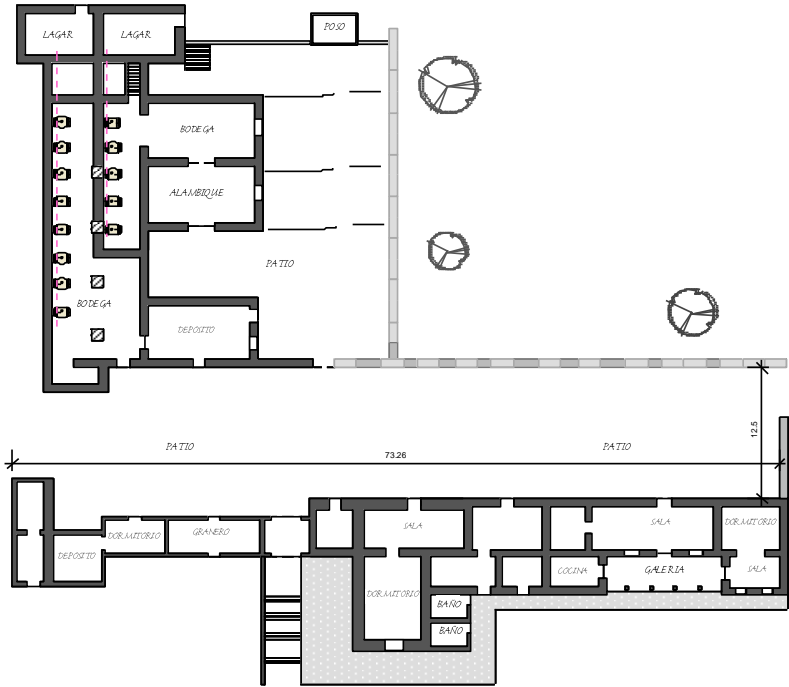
Levantamiento en planta de Hacienda y Bodega.
